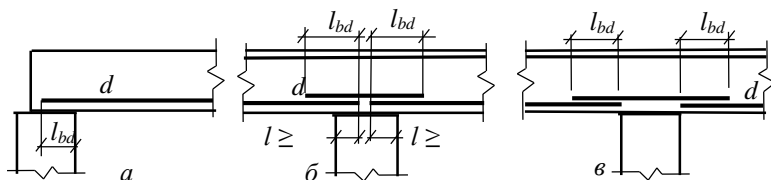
Анкерування нижньої арматури: а – на крайній опорі; б, в – варіанти анкерування на проміжних опорах
